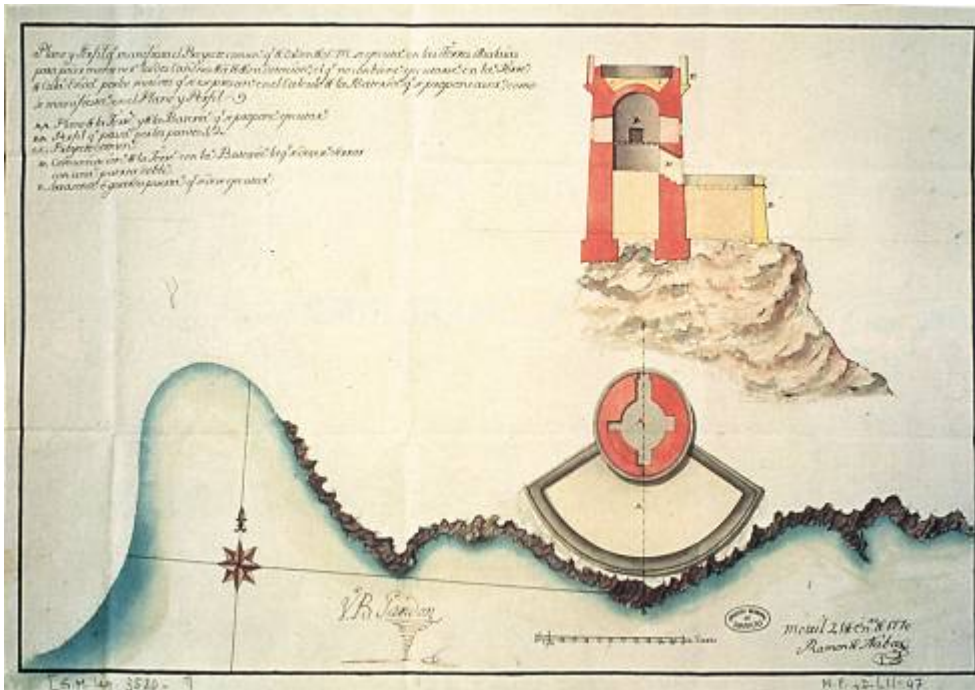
Planta y alzado de la Torre del Zambullón, situada por encima de la localidad de Calahonda, con el parapeto que se le proyecta en 1770 para que pudiese albergar artillería. (Archivo General de Simancas, G.M., M, P. y D., LII-47)
